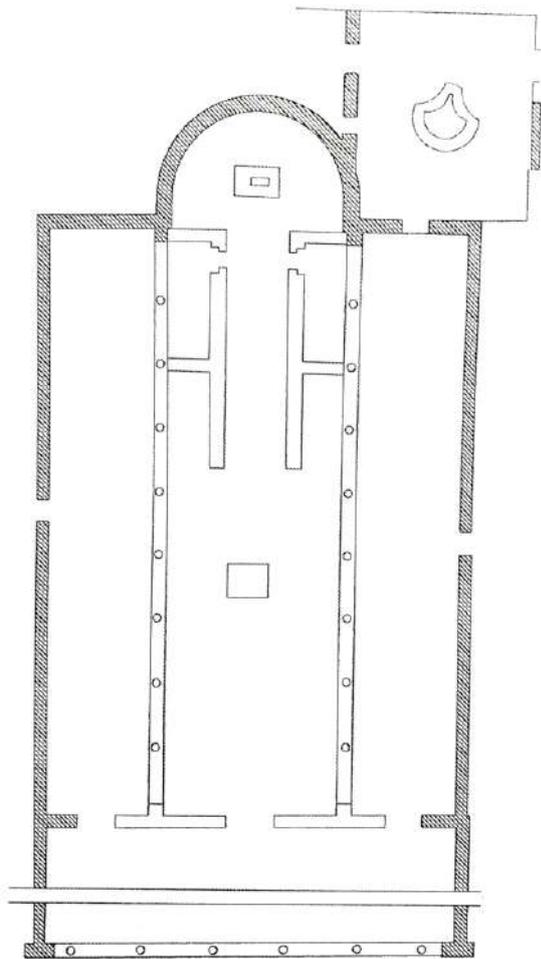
Santo Stefano in Via Latina, Grundriss der in der Villa eingebauten Kirche
